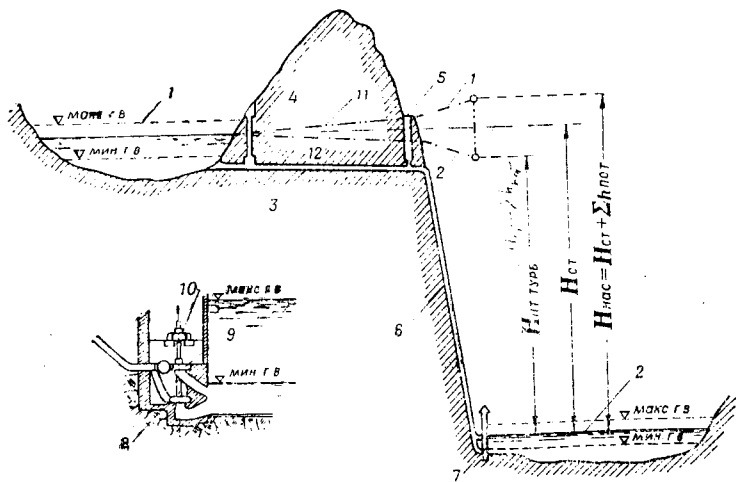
Продольный разрез гидроаккумулирующей электростанции: 1—верхний резервуар; 2—нижний резервуар; 3—напорный тоннель; 4—шахта для затворов; 5—уравнительный резервуар; 6—напорный трубопровод; 7—здание ГАЭС; 8—насос; 9—турбина; 10—мотор-генератор; 11 и 12—линии энергии
